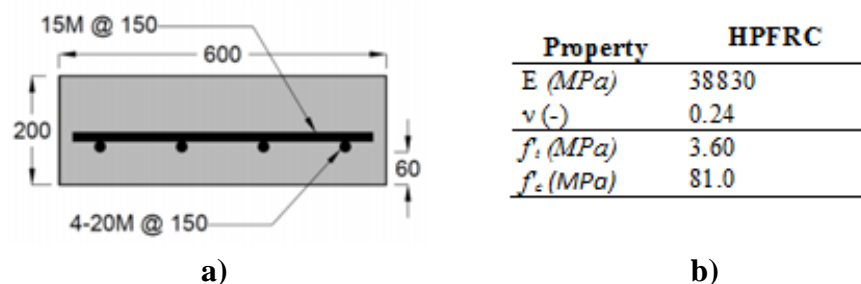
Dalle en BFHP, a) Section transversale, b) Propriétés mécaniques, (Lachance et al., 2016)
